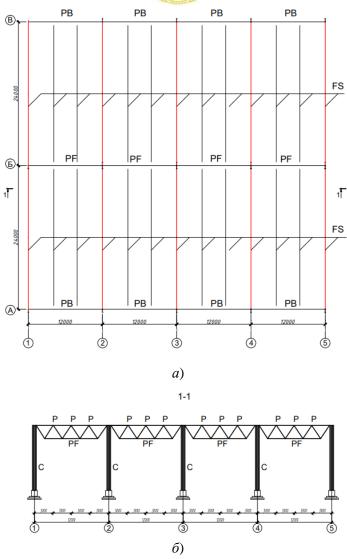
Торговый центр: a — вид сверху; δ — вид в разрезе 1–1
